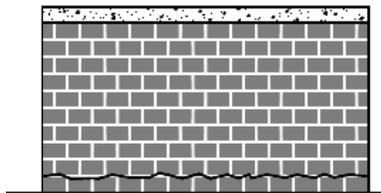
, 3 e 4: Trincas provenientes da expansão dos tijolos, Trincas em peças estruturais e Fissuração no canto do edifício por absorção de umidade por parte dos tijolos
